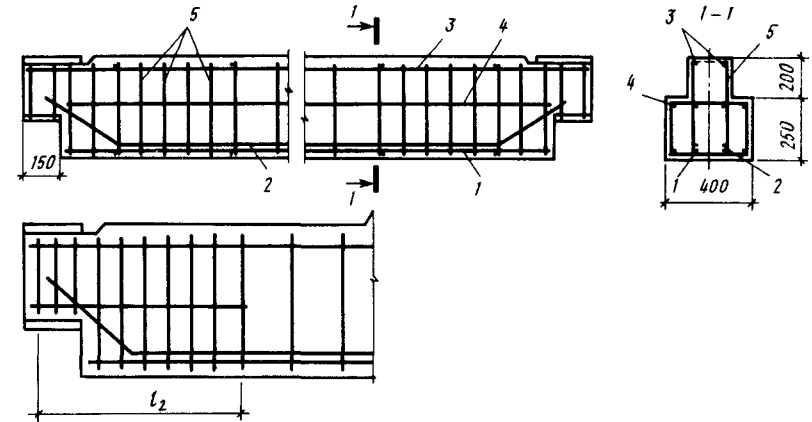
Армирование ригеля таврового сечения для гражданских зданий: 1...5 — номера стержней
